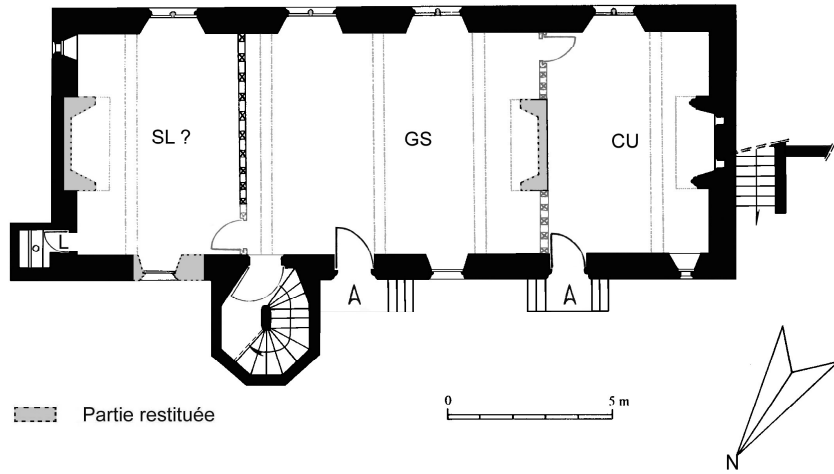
Les Rocques. Plan restitué du rez-de-chaussée entre 1522 et 1532.
